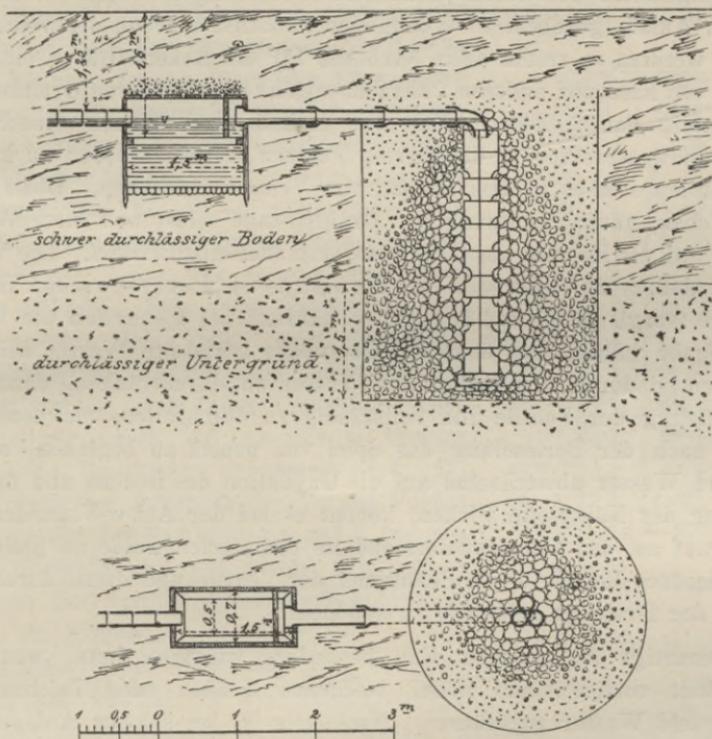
und 516. Senkbrunnen mit Schlammfang. Längenschnitt und Grundriss.
